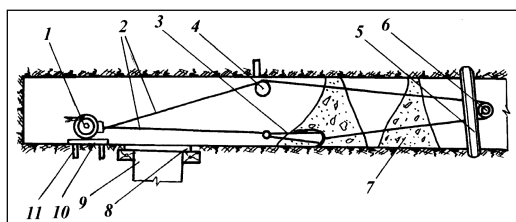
Схеми скреперної доставки: 1 - лебідка; 2 - канат; 3 - скрепер; 4 - підвісний блок; 5 - кінцева балка; 6 - кінцевий блок; 7 - дучки з корисною копалиною; 8 - грохот; 9 - перемісний гезенк; 10 - монтажна рама; 11 - анкерне кріплення.
